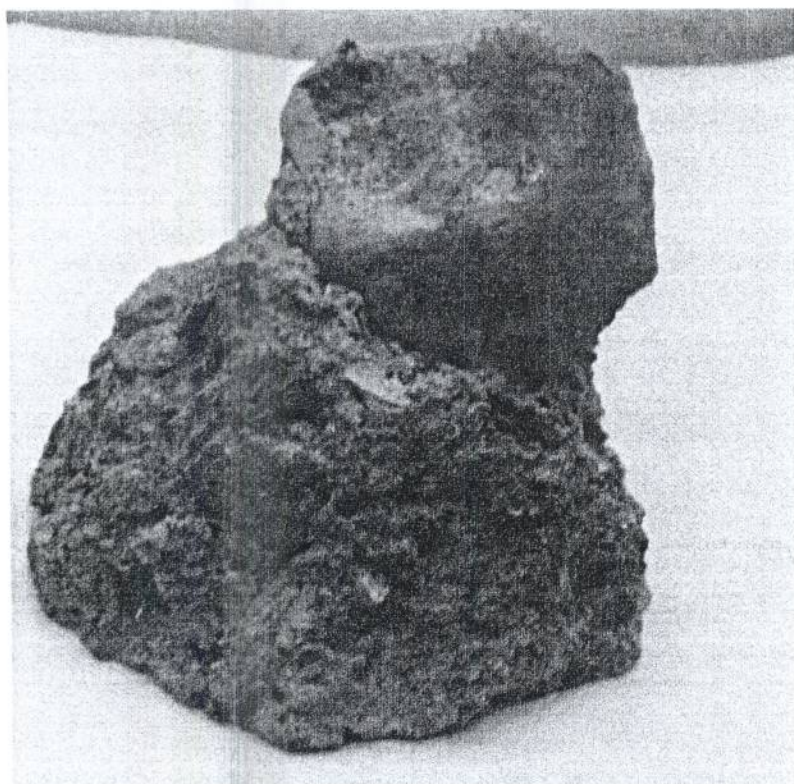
Pohled na fragment betonu z jádrového vývrtu se zřejmou přítomností škváry (v červeném kroužku)
